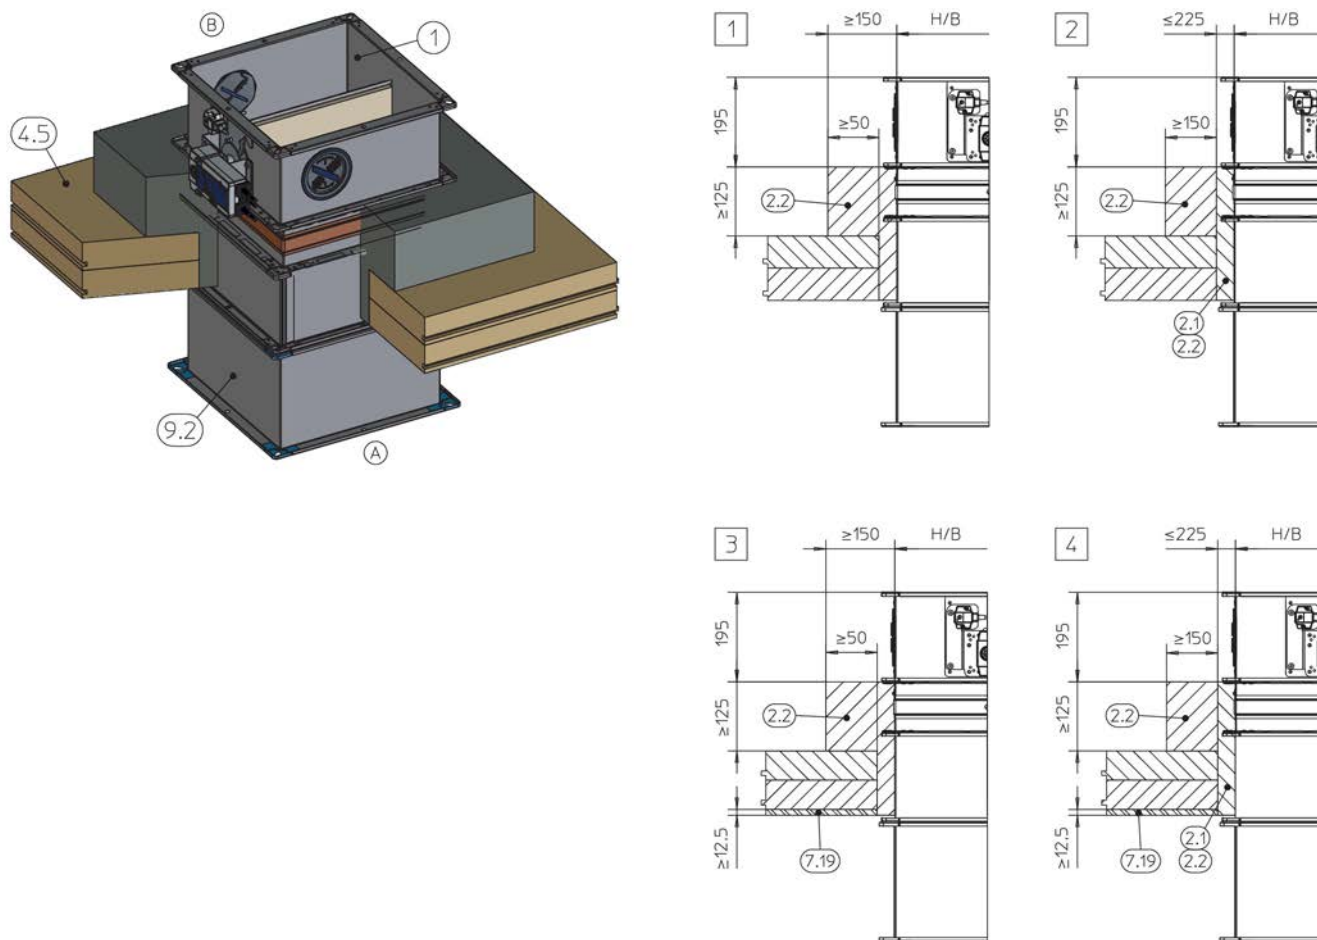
Installazione in muratura in soffitto in soletta solido in collegamento con soffitti con travi di legno / laminate, verticale (figura esemplificativa, utilizzabile per altri modelli di soffitto con travi di legno)
